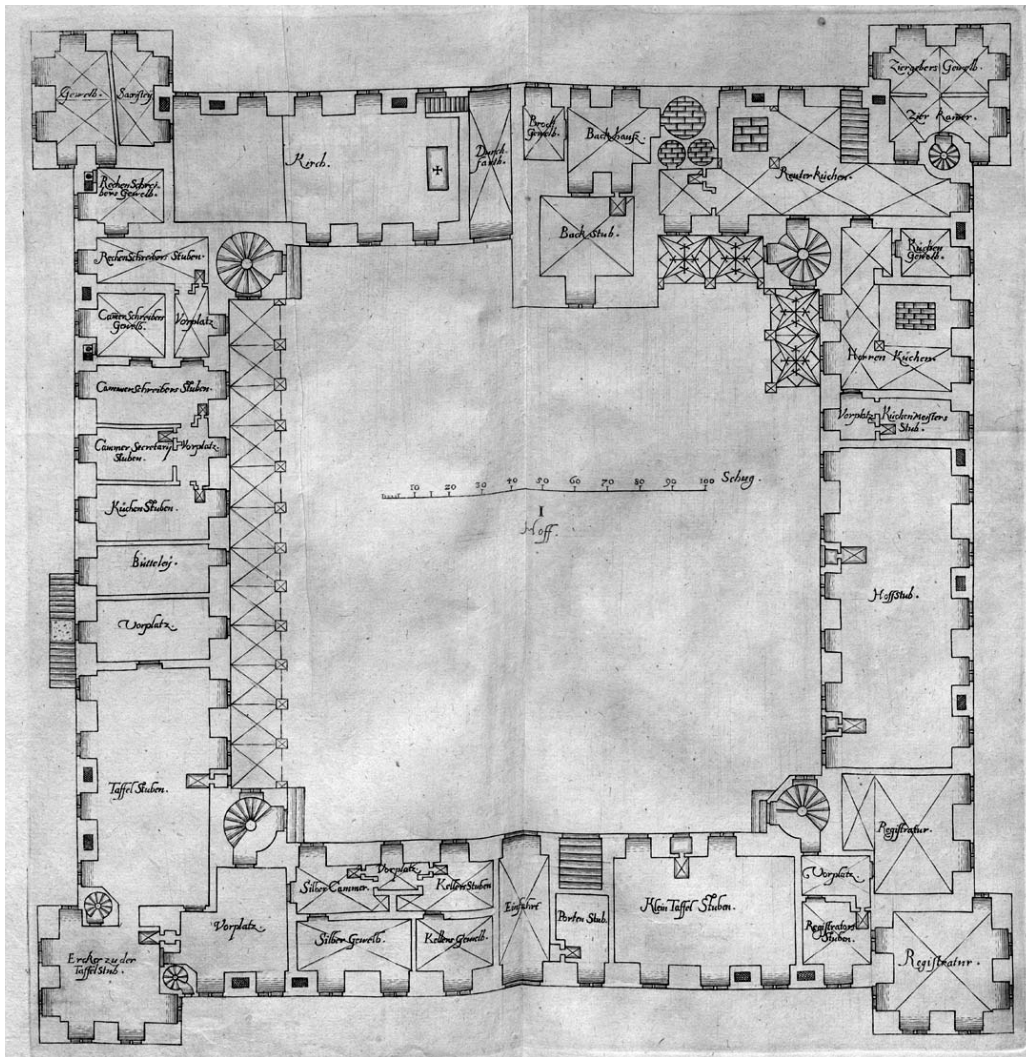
Georg Ridinger, Aschaffenburg, Schloss, orthogonaler Erdgeschossgrundriss, 1616
